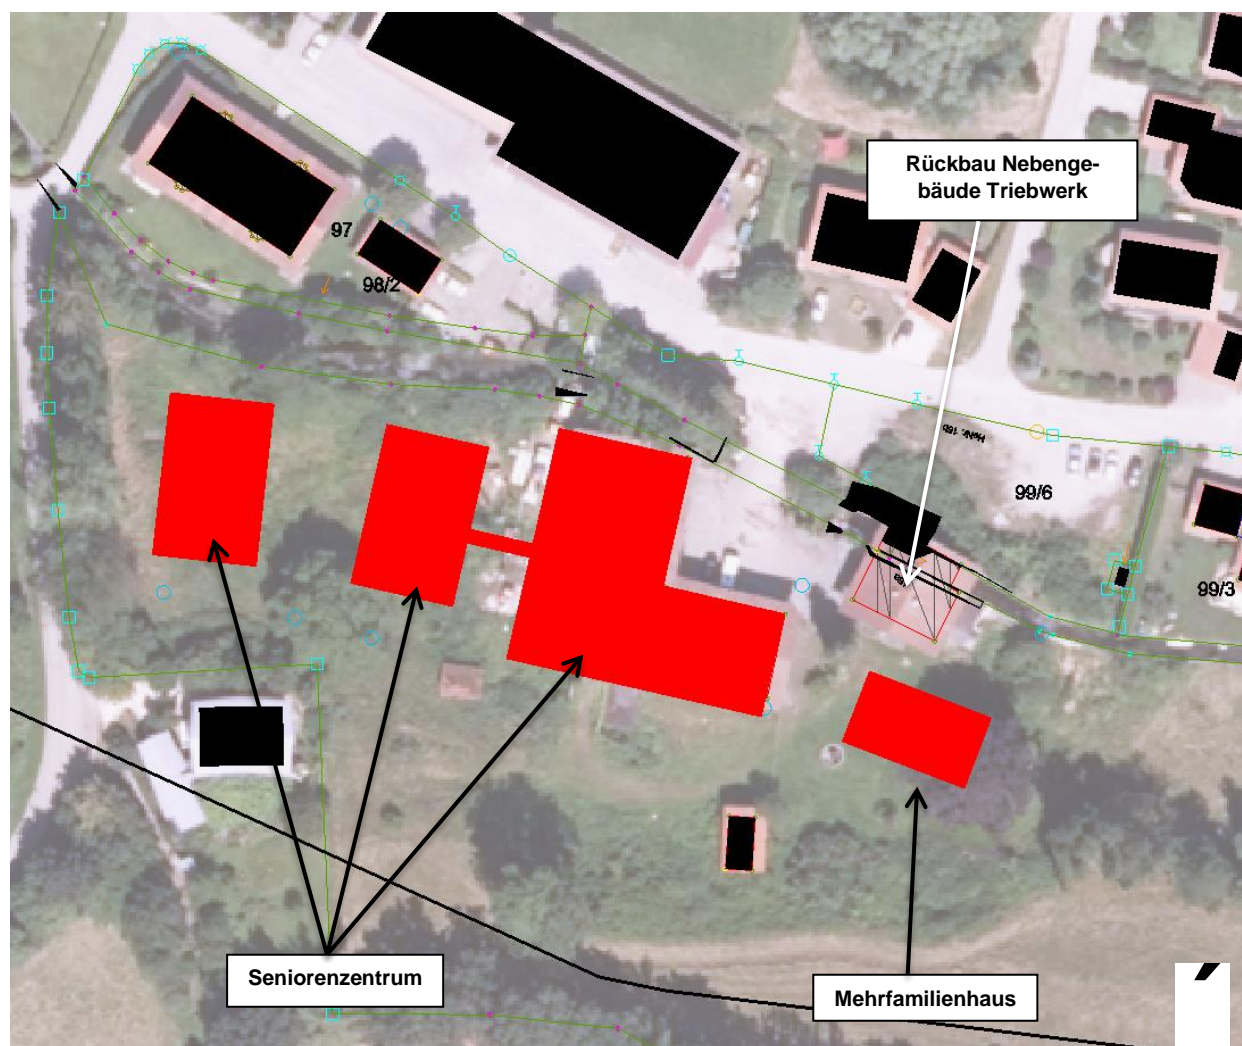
Modellierung Planungsrechenlauf, "Disable"-Flächen rot dargestellt
